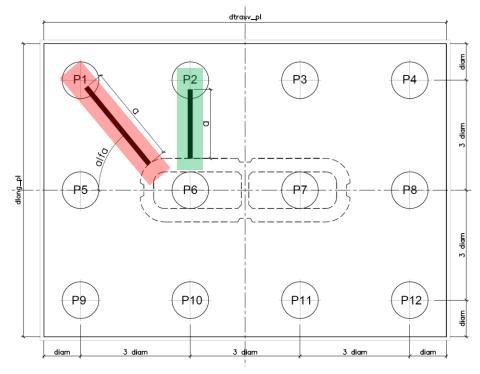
Vista in pianta - Tirante-puntone longitudinale (verde) e diagonale (rosso)
